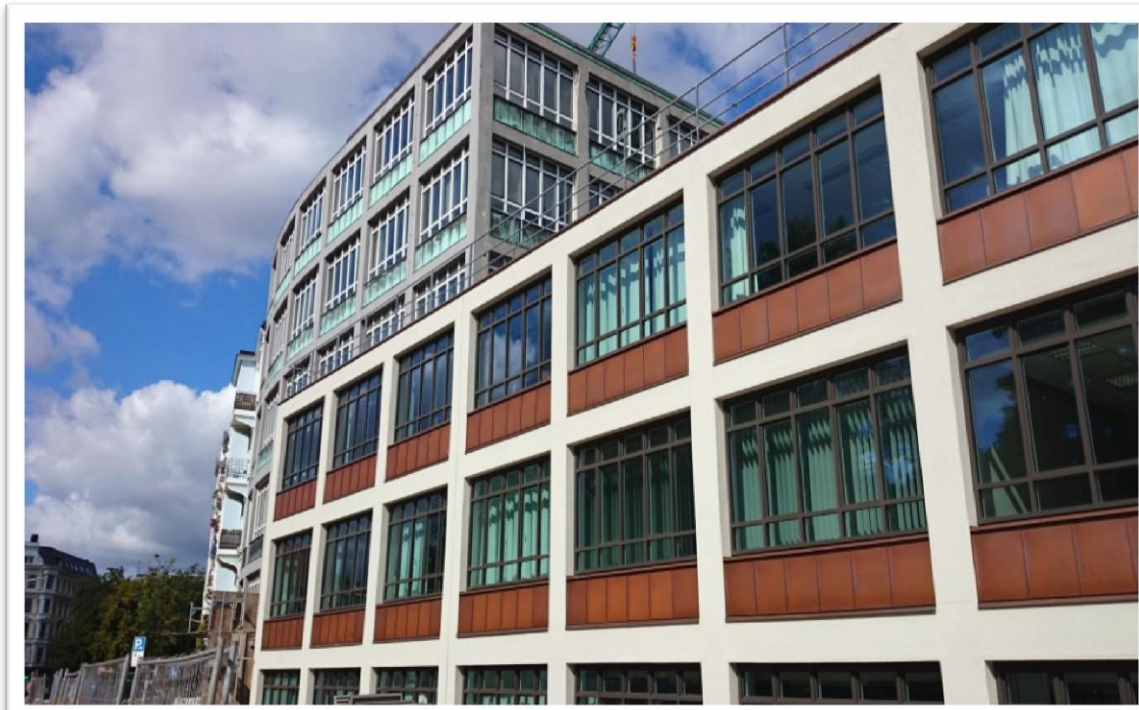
Sanierete Fassade (links) Bestandsfassade (rechts)
